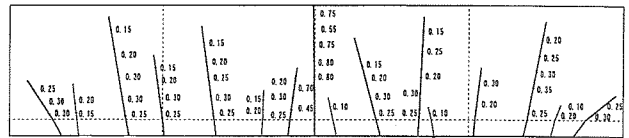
ひび割れ発生図（第2ブロック中壁）
